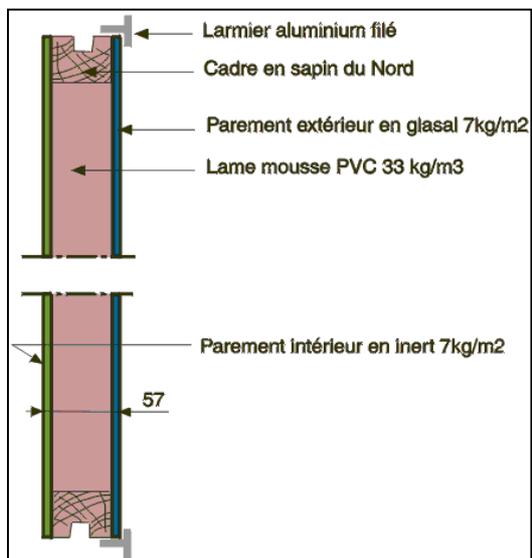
Panneau sandwich de type "KLEGEPA" – fabrication "POLYPLAC" - vue en coupe
